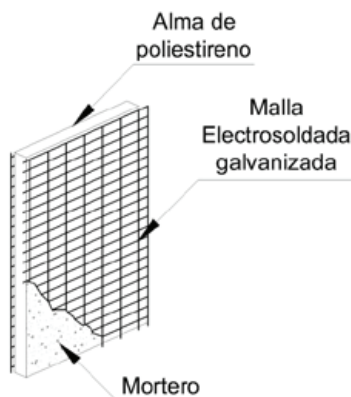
Sistema con Malla electro-soldada y pasadores galvanizados y alma de poliestireno, la superficie recubierta con hormigón ó mortero
